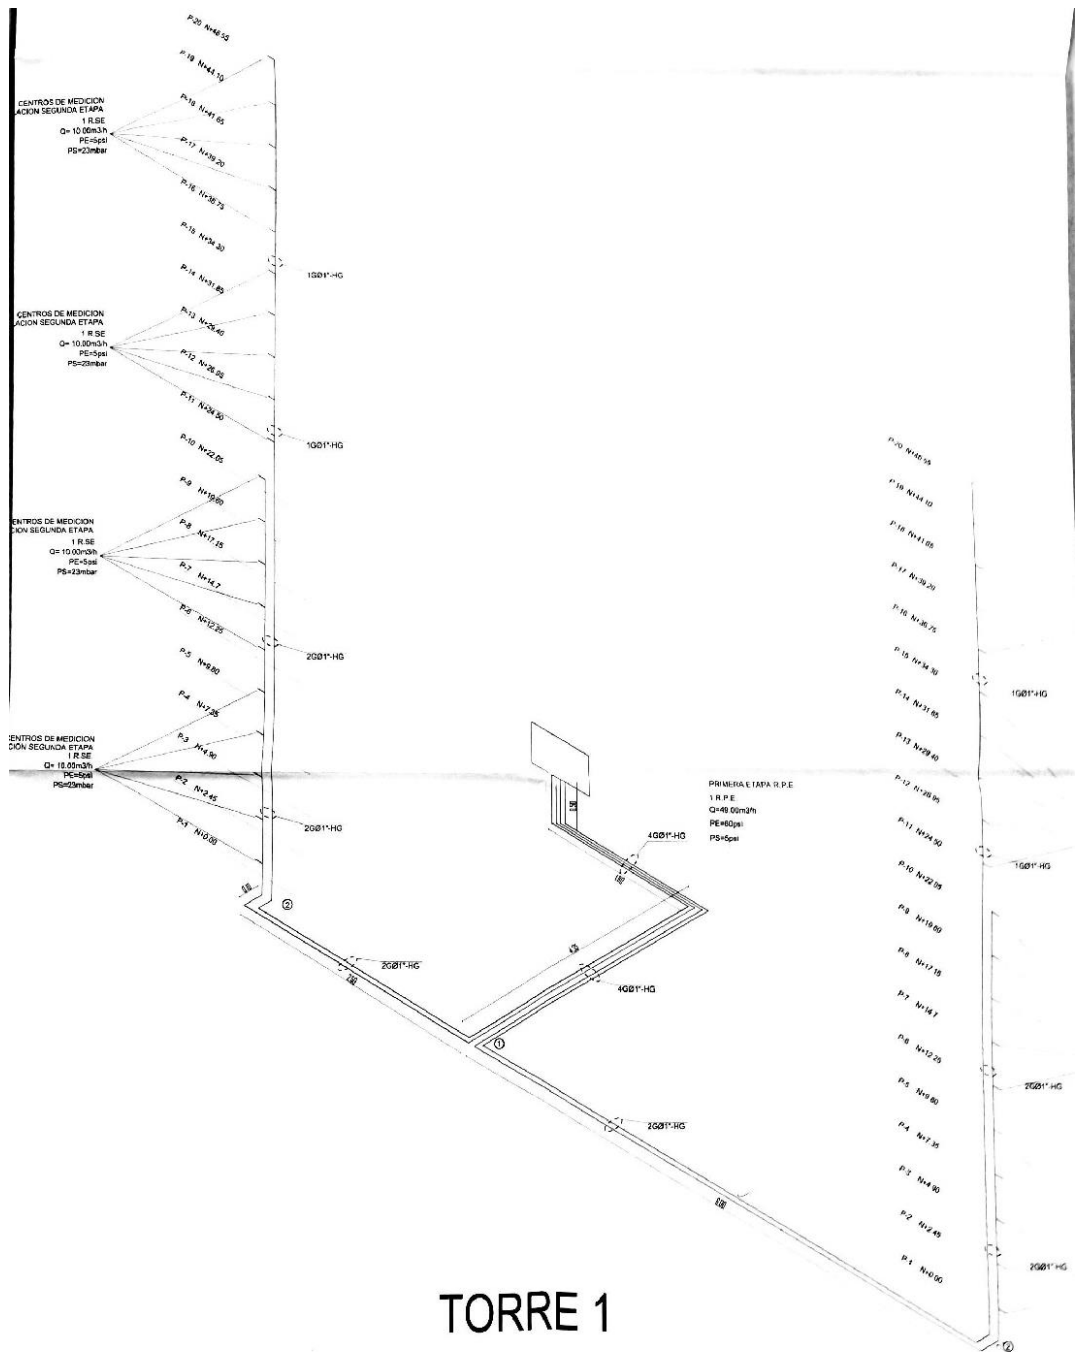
Planta de red interna de gas del PROYECTO VENTURA
